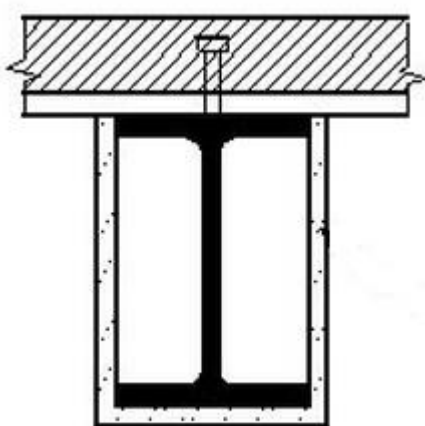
Viga metálica protegida por placas de gesso. [34]
